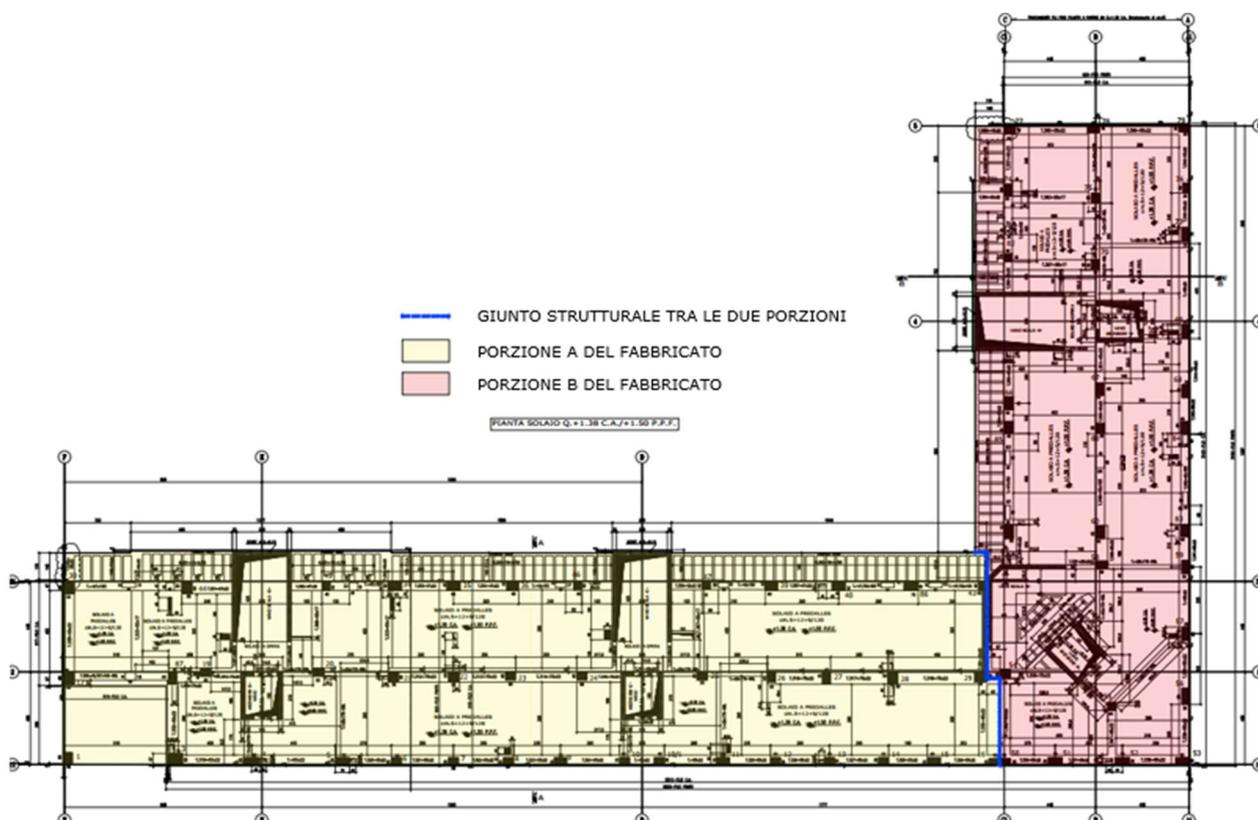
Planimetria piano tipo con suddivisione delle porzioni – Caso Torino
